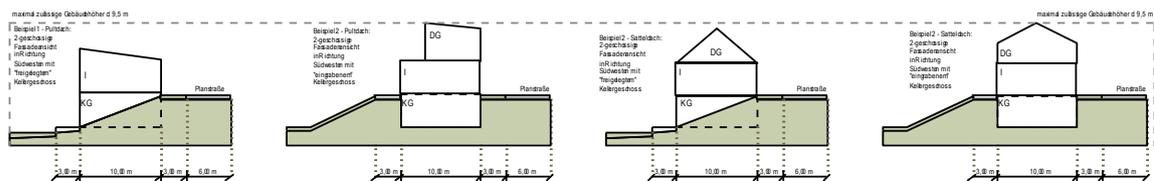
Darstellung der Fassadengestaltung und -höhe, Stand April 2024
